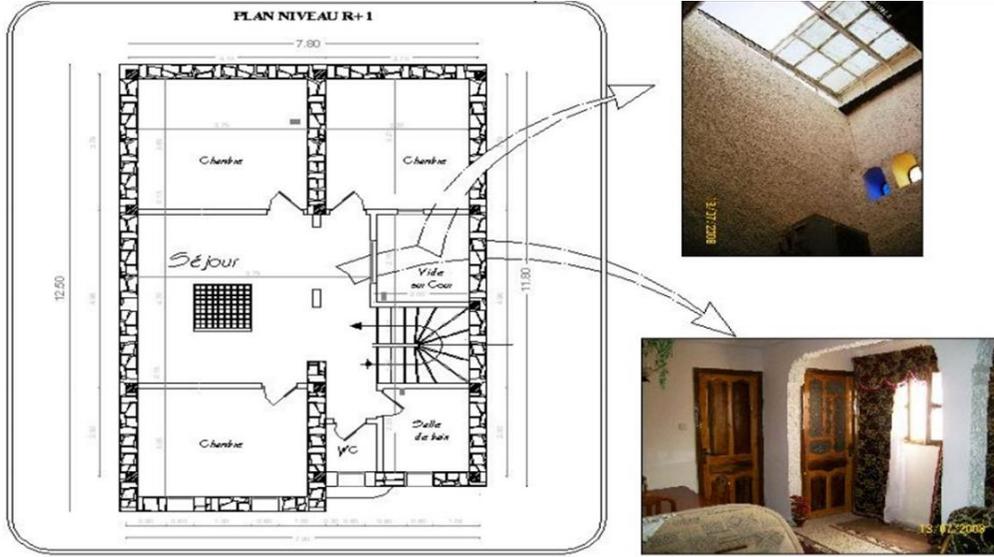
مخطط الطابق لأرضي لمسكن بقصر تافيلالت
